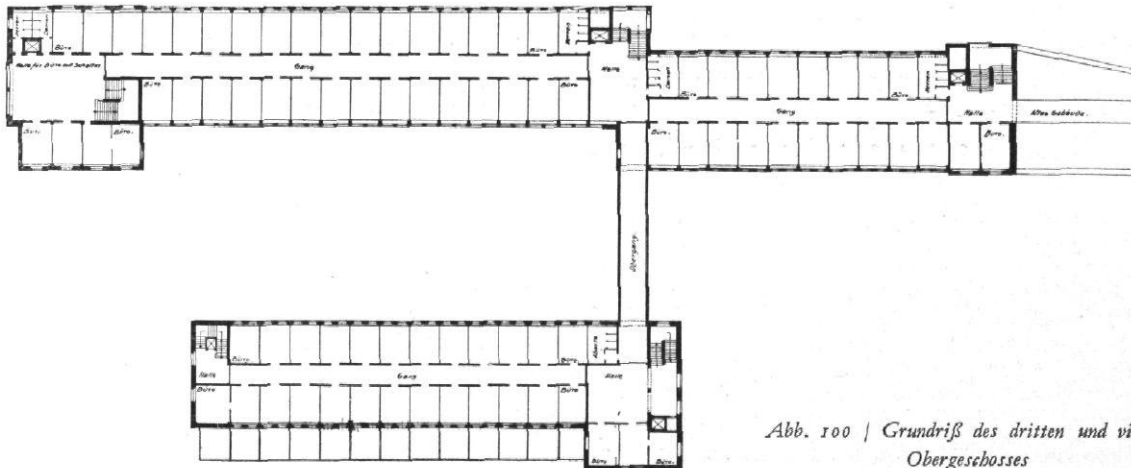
| Grundriß des dritten und vierten Obergeschosses
